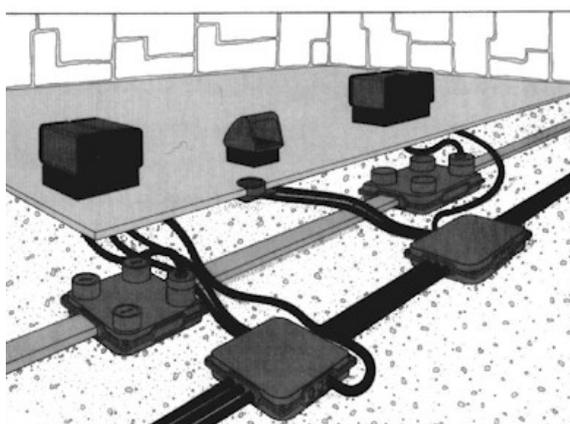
Distribuzione in passerella, esecuzione sotto pavimento
